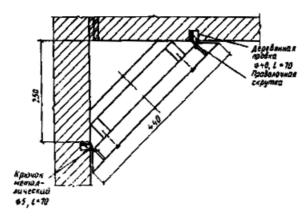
Крепление щитов сборно-разборной опалубки к стенам при утеплении вертикальных углов Рабочие последовательно устанавливают и закрепляют нижний, средний и верхний щиты опалубки с последовательным бетонированием после каждой установки элементов опалубки. Щиты соединяются между собой с помощью дощатых направляющих и упорных поперечин. Поверхность щитов со стороны утепления перед началом производства работ следует олифить. Бетонирование осуществляет бетонщик с помощью штукатура, который при работе бетонщика с подмостей подаёт ему материал, укладывая керамзитобетон марки М 50 ковшом. При этом бетонщик тщательно уплотняет свежеуложенную керамзитобетонную массу с помощью скребкашуровки.
